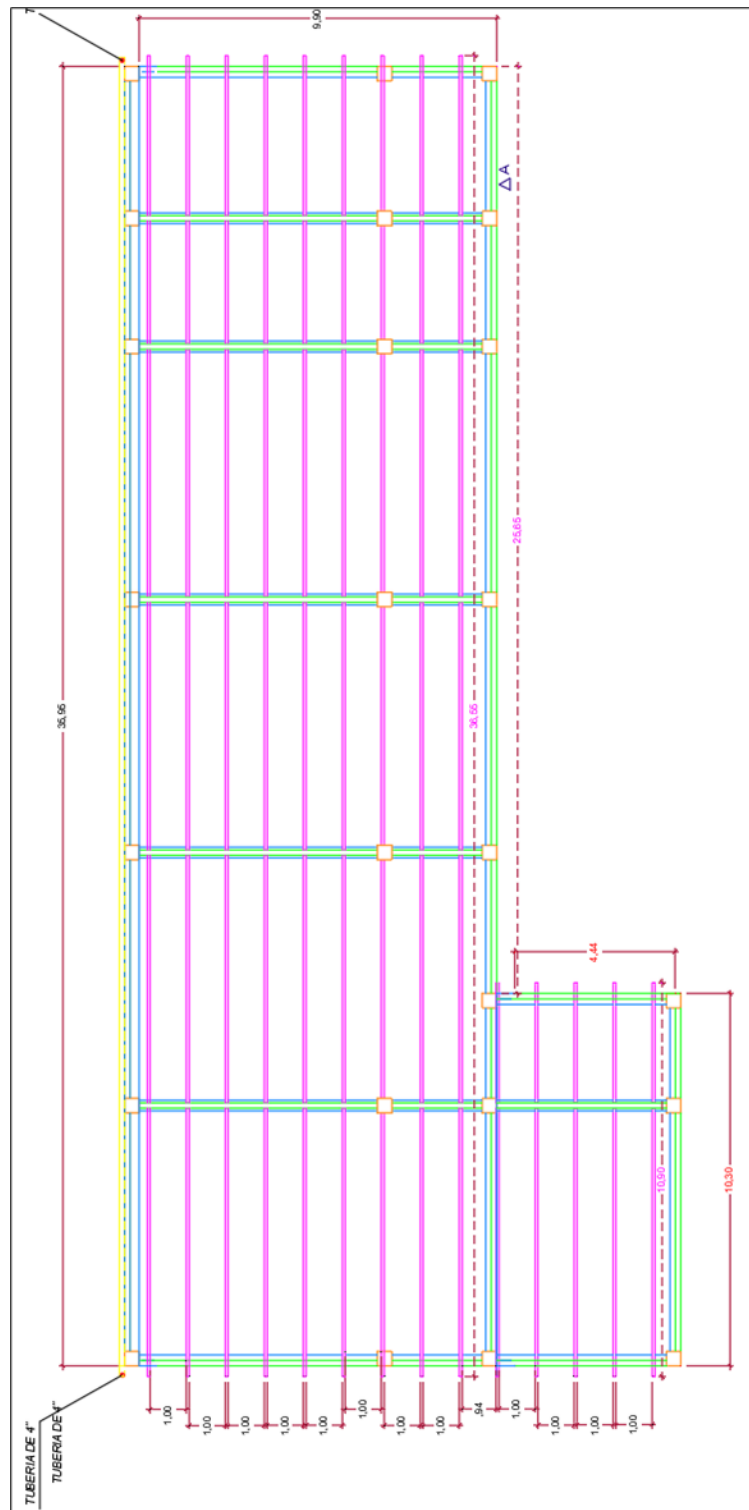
Vista en planta de entramado de perfil de acero, de la estructura 2 del Centro de Desarrollo Infantil.
